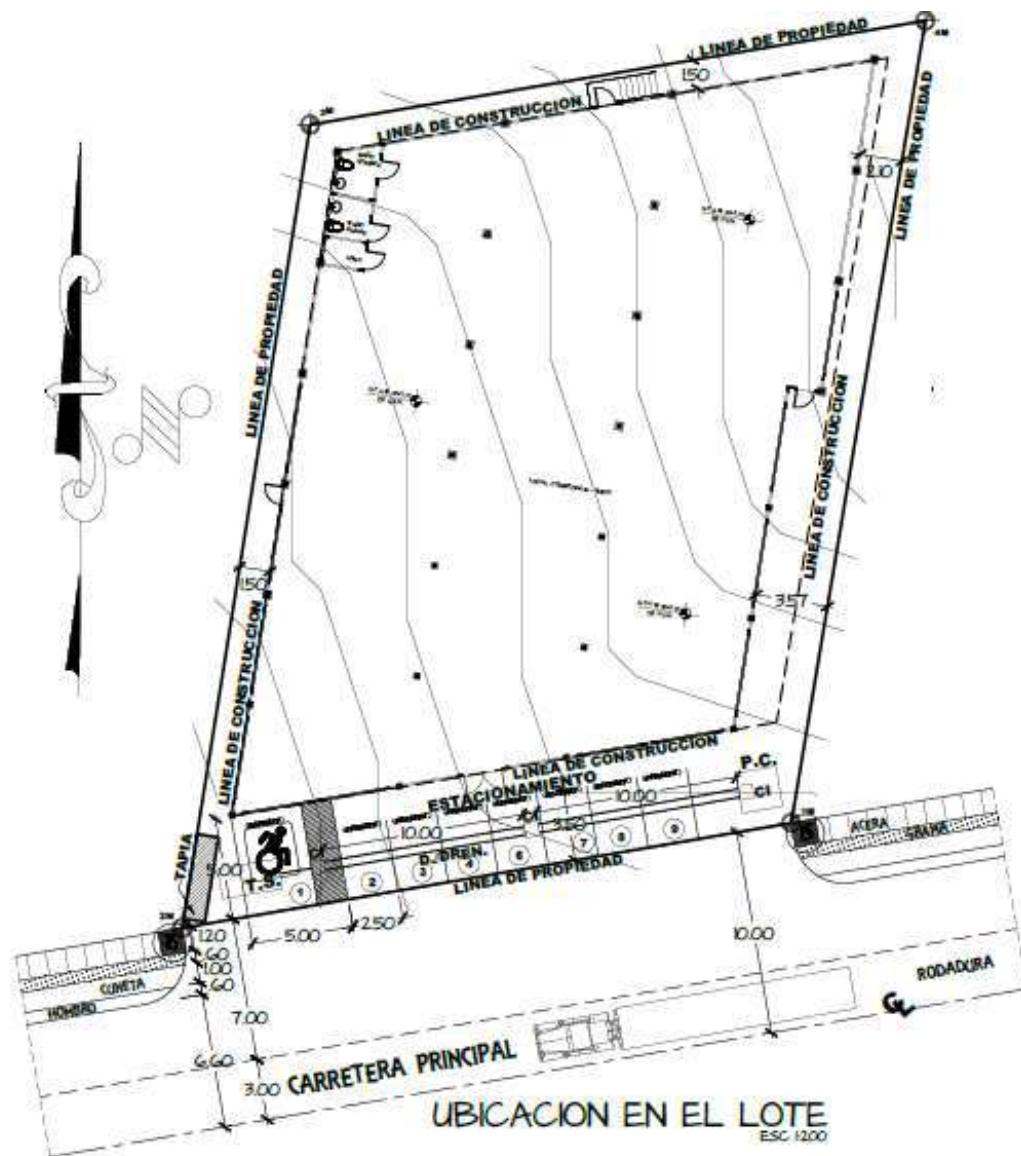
Ubicación del proyecto en el lote. Fuente. Plano del proyecto
